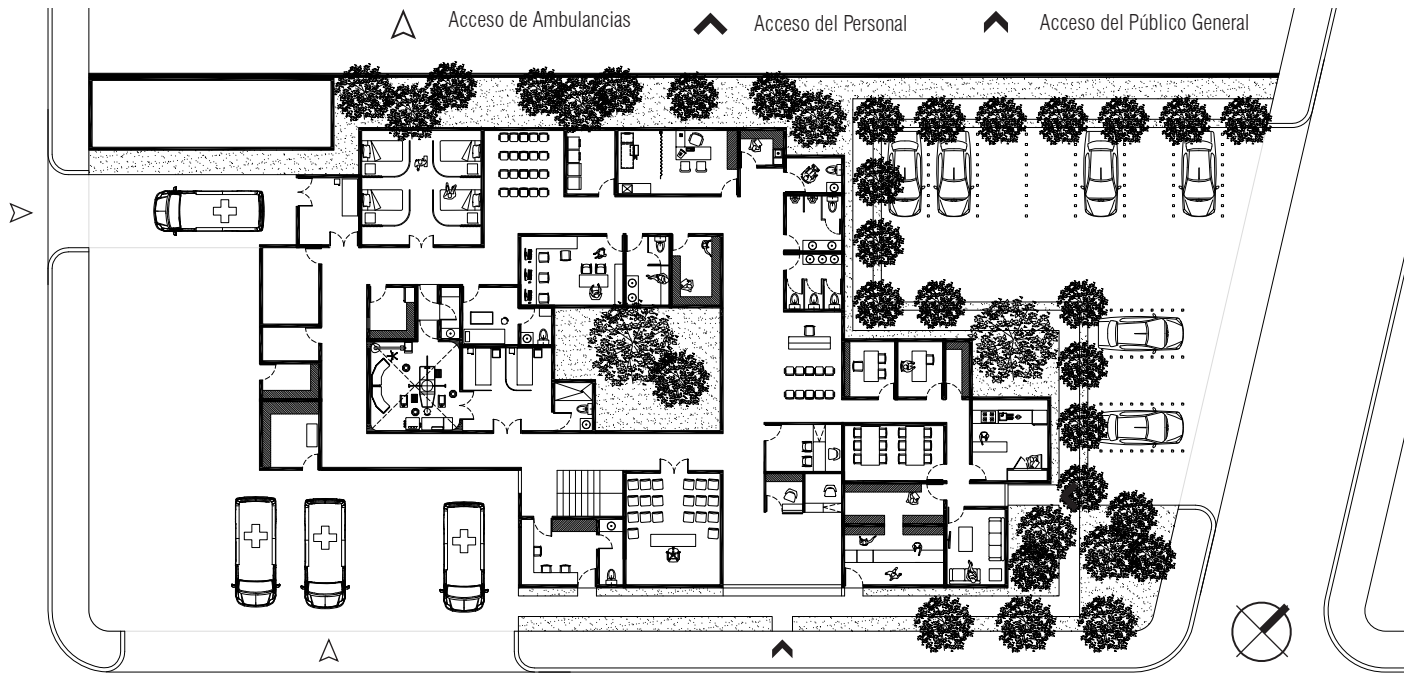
| Prototipo Delegación Media para el grupo climático tres | Planta Baja
